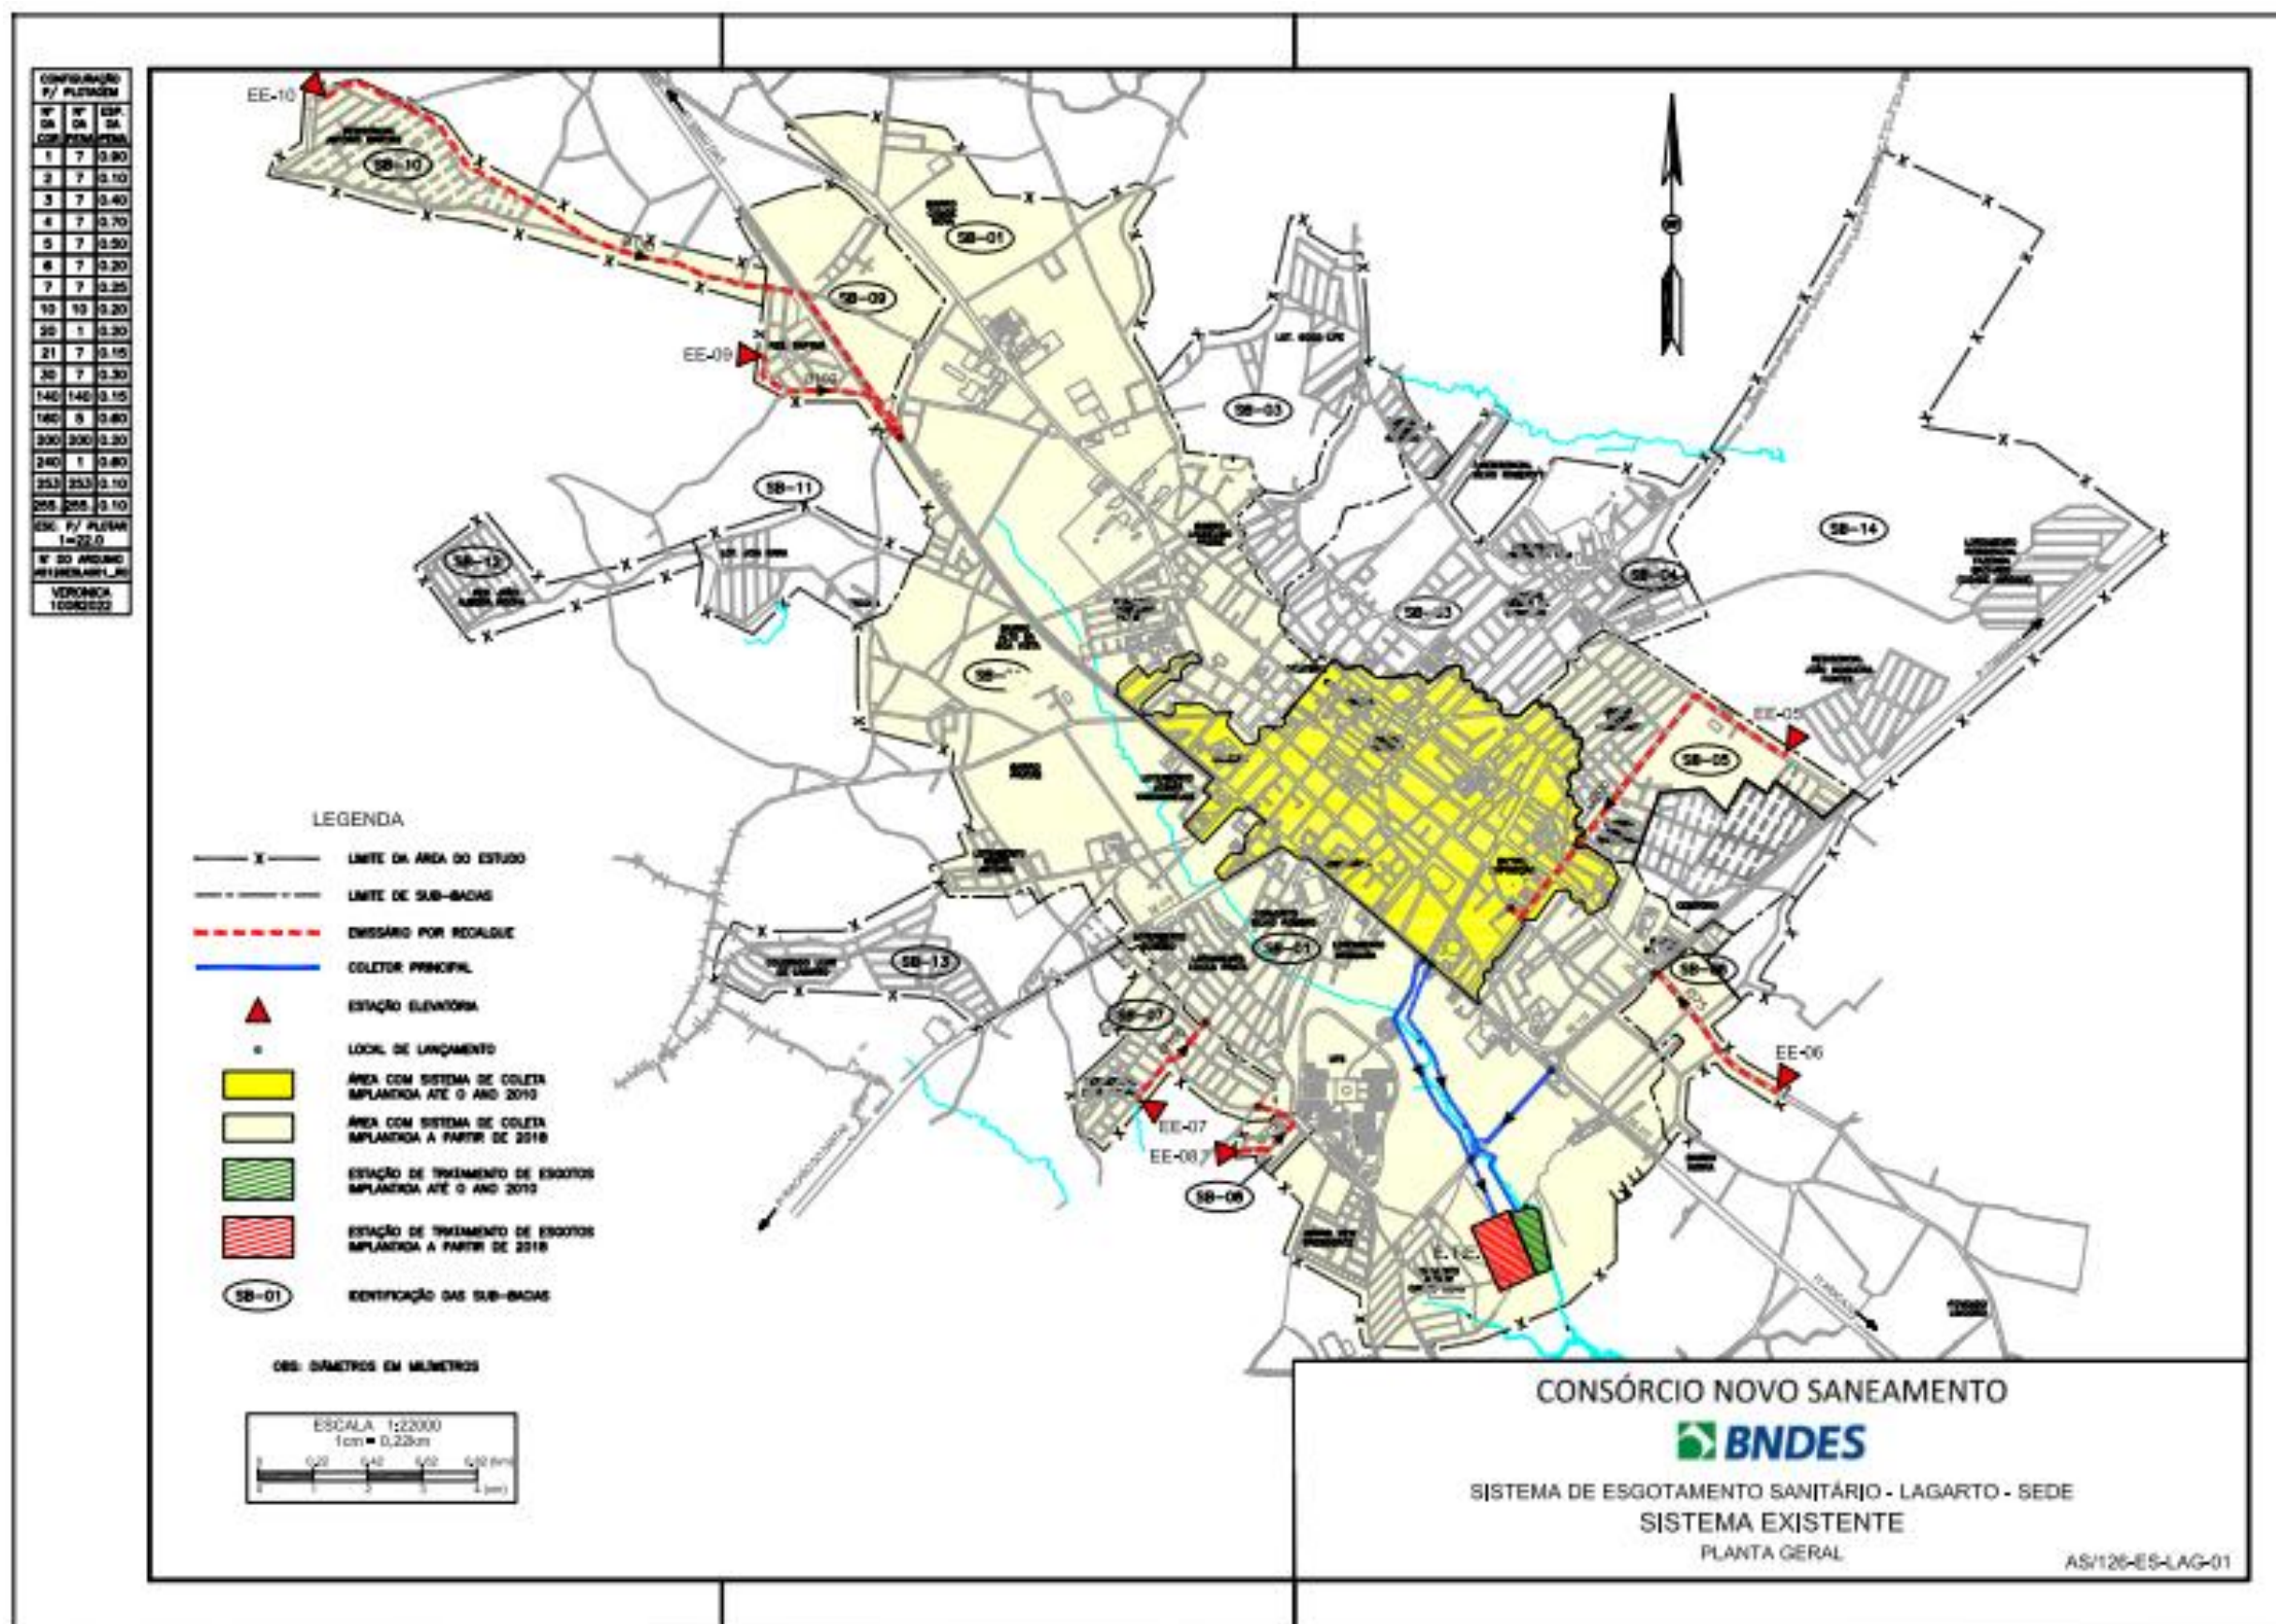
Planta do Sistema de Esgotamento Sanitário – LAGARTO
